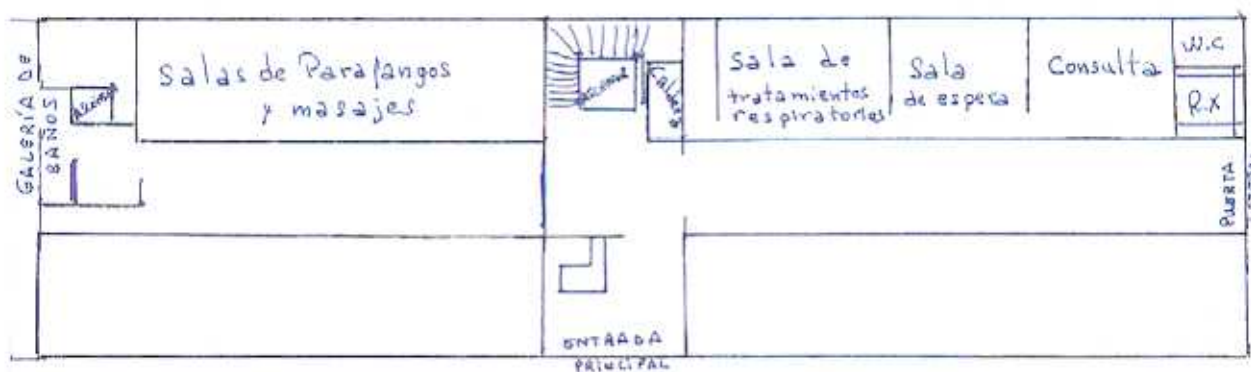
Plano planta baja del Hotel el Parque.(Termas Pallarés)
